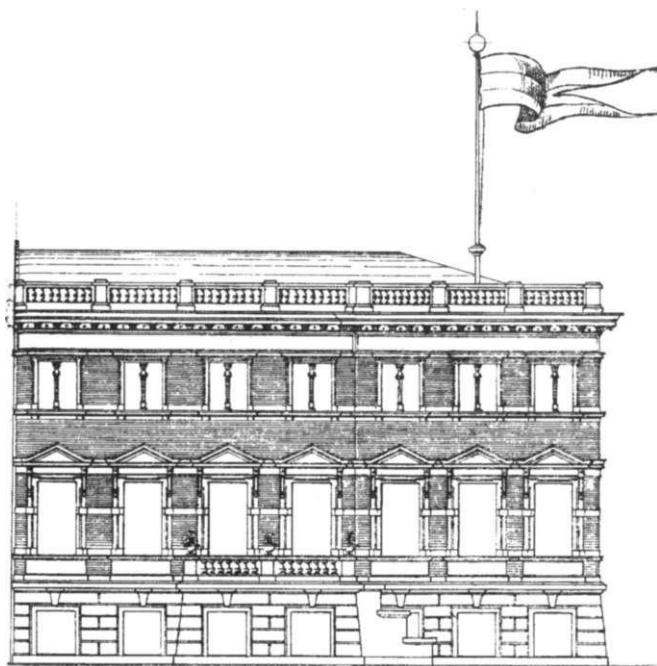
Olvenstedter Straße 37, Fassade des Wohnhauses
